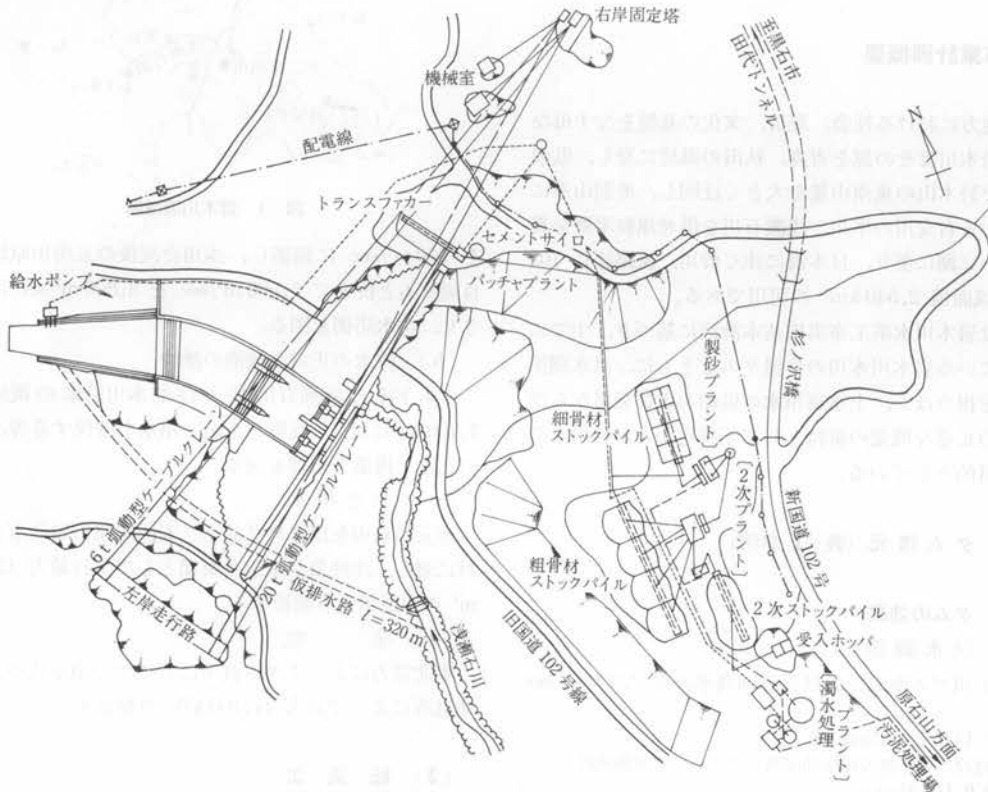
浅瀬石川ダム施工設備平面図 (ダムサイト)
